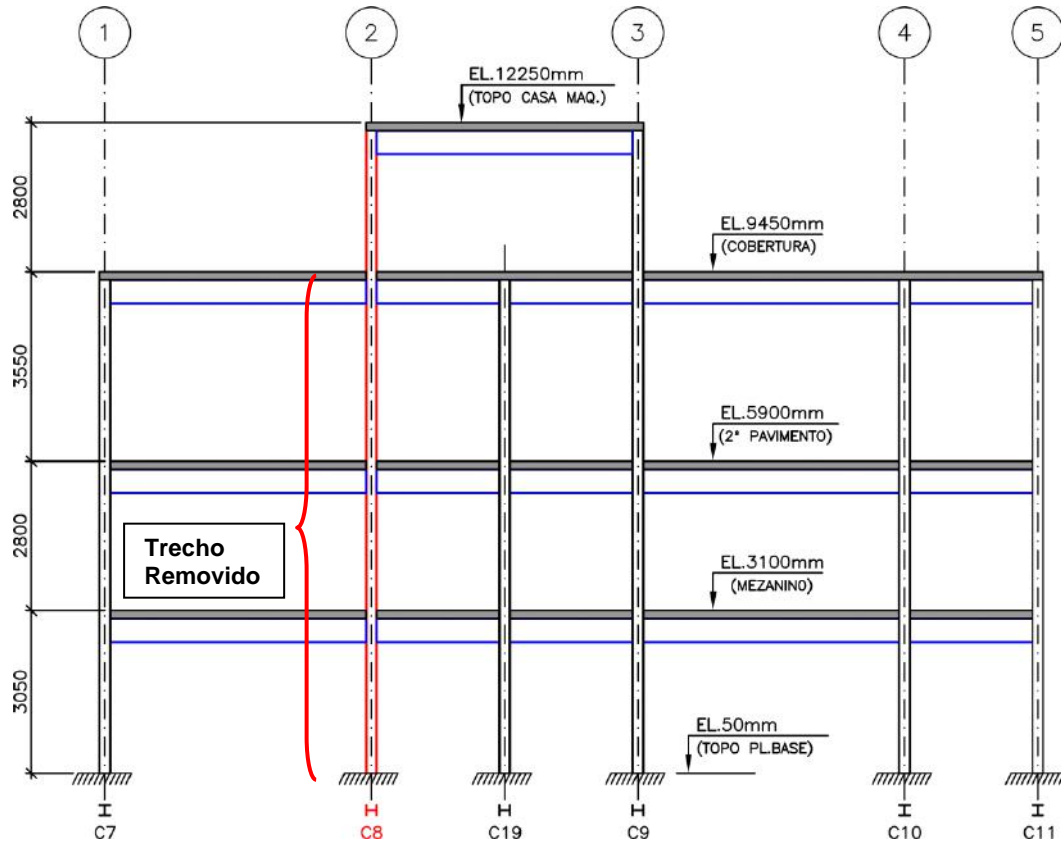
Elevação Eixo B – Dimensões em mm
